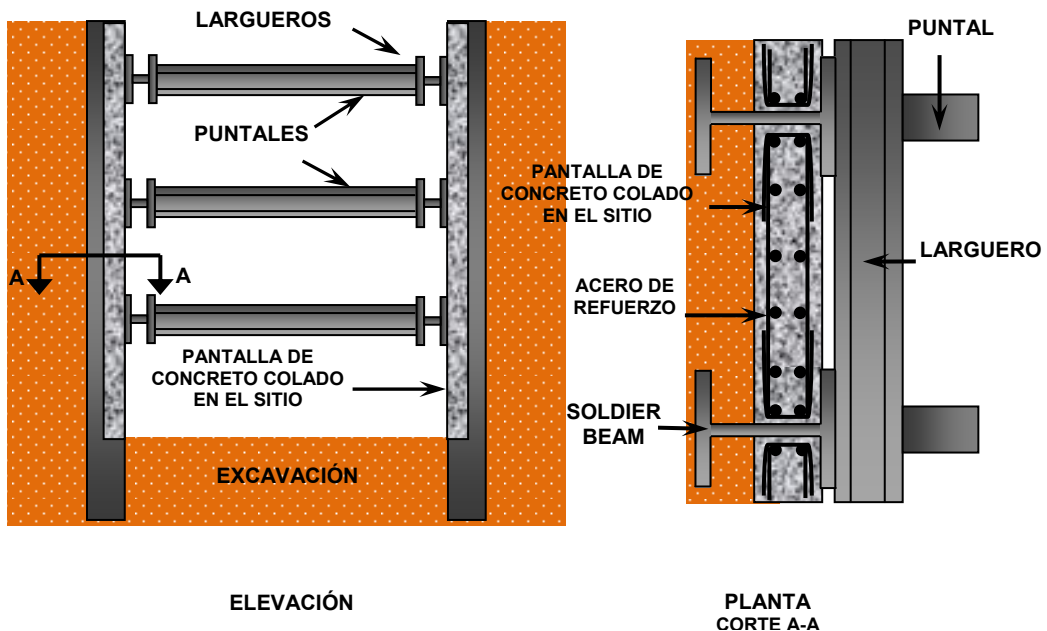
Revestimiento de concreto colado en el sitio, colocado entre soldier beams.
